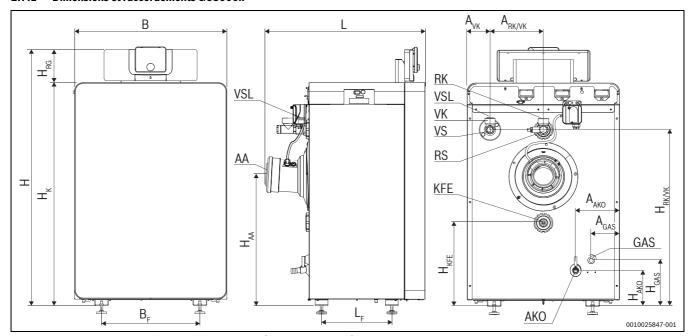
Dimensions et raccordements de la GC8000iF (dimensions en mm)
